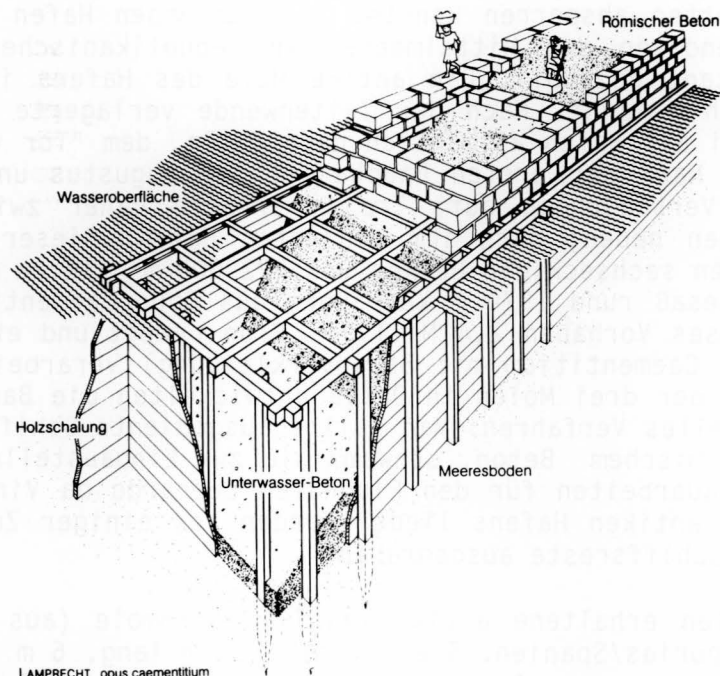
Herstellung einer Hafemole mit Unterwasser-Beton gemäß Vitruv. Zum Bau wurden hölzerne Schalwände mit Hilfe von Balken ins Wasser gebaut und der speziell hergestellte hydraulische Beton in das so entstandene wassergefüllte Becken geschüttet.
